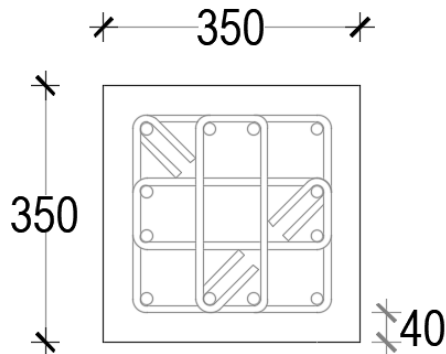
Armado de columnas #11 y #13 de entepiso y cubierta
